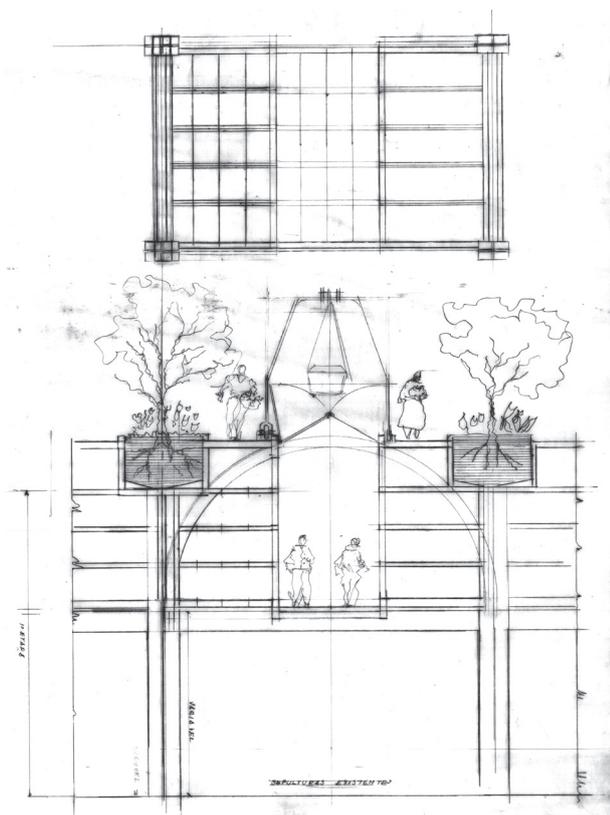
| Detalhe do corte e da planta de um módulo da proposta de Rebouças para ampliação vertical do cemitério do Campo Santo
